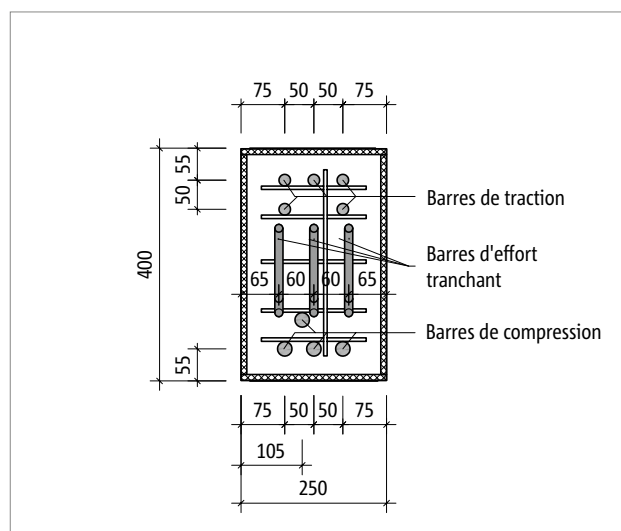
Schöck Isokorb® T Type B-M7-V1 en hauteur H400 : Vue du produit
